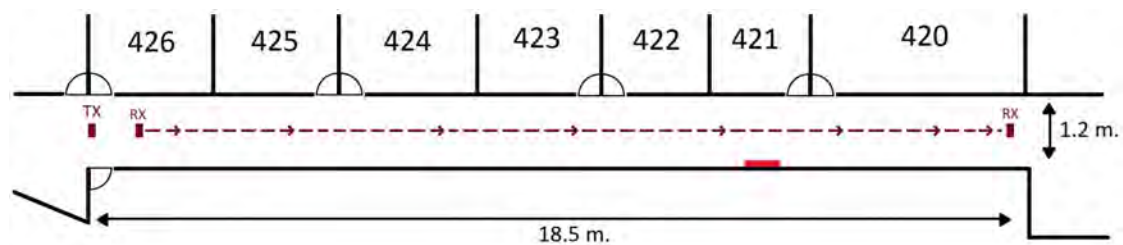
Plano del pasillo estrecho, Planta 4, Edificio B
